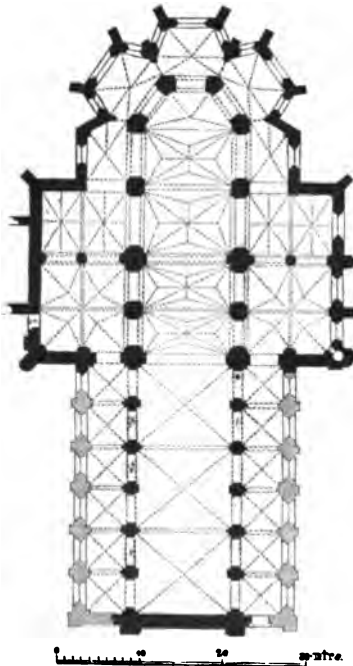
Grundriss von Dargun. (Nach Dohme.)
